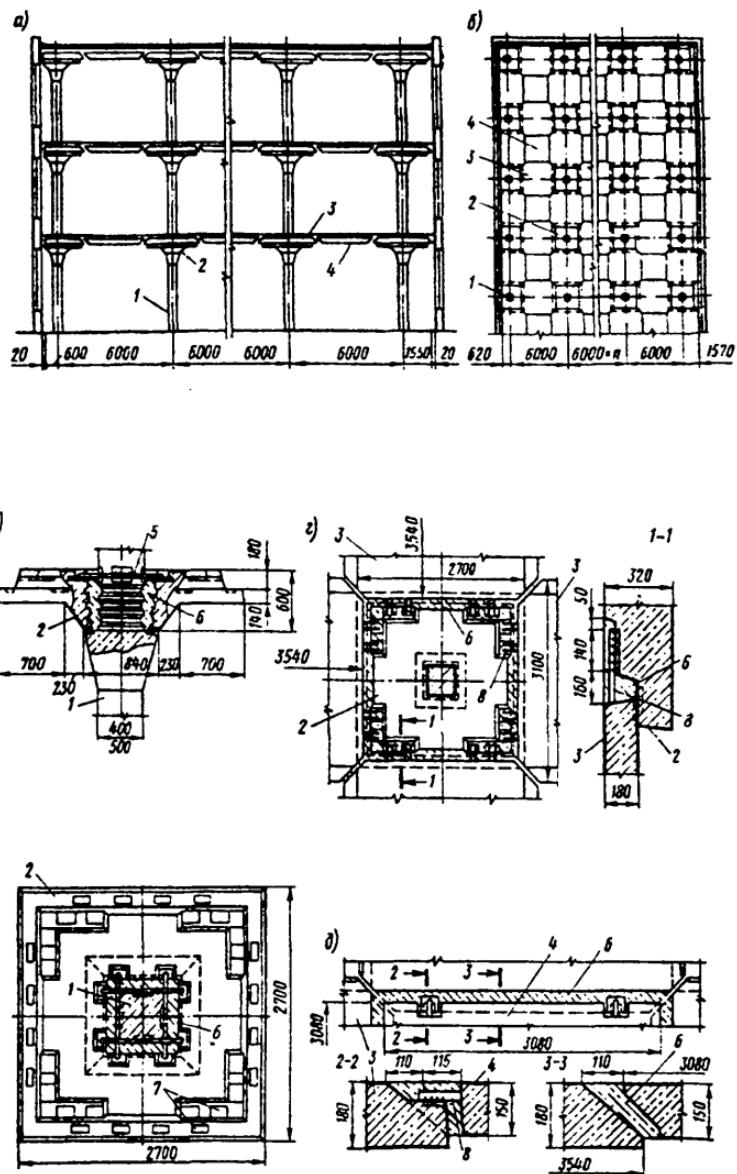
Многоэтажное здание с безбалочным каркасом:
